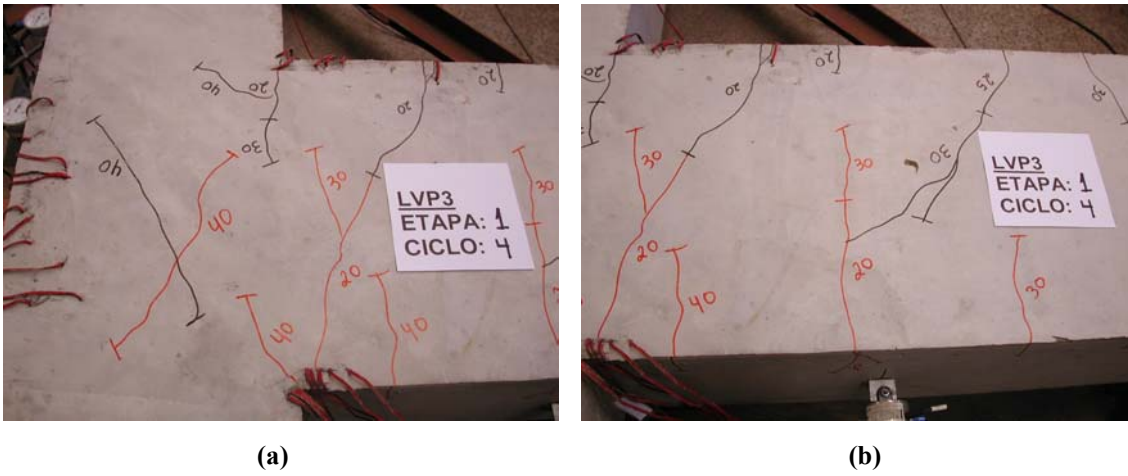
Detalhe das fissuras do pórtico de Alva, $F = \mp 40\text{KN}$: (a) nó, (b) viga
